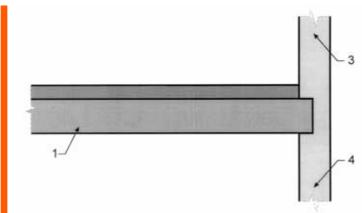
Dalles de 20 cm d'épaisseur avec une chape de 8 cm perpendiculaires à la façade en béton armé de 18 cm d'épaisseur
